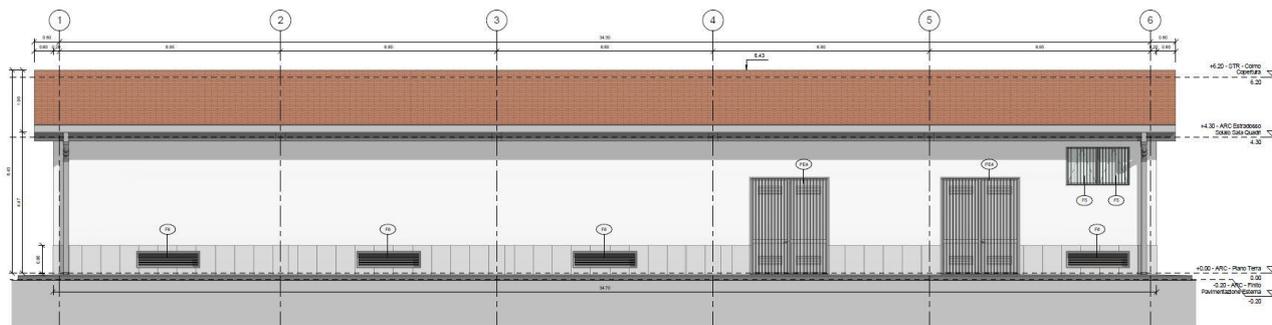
SSE Avigliana – Prospetto Ovest
